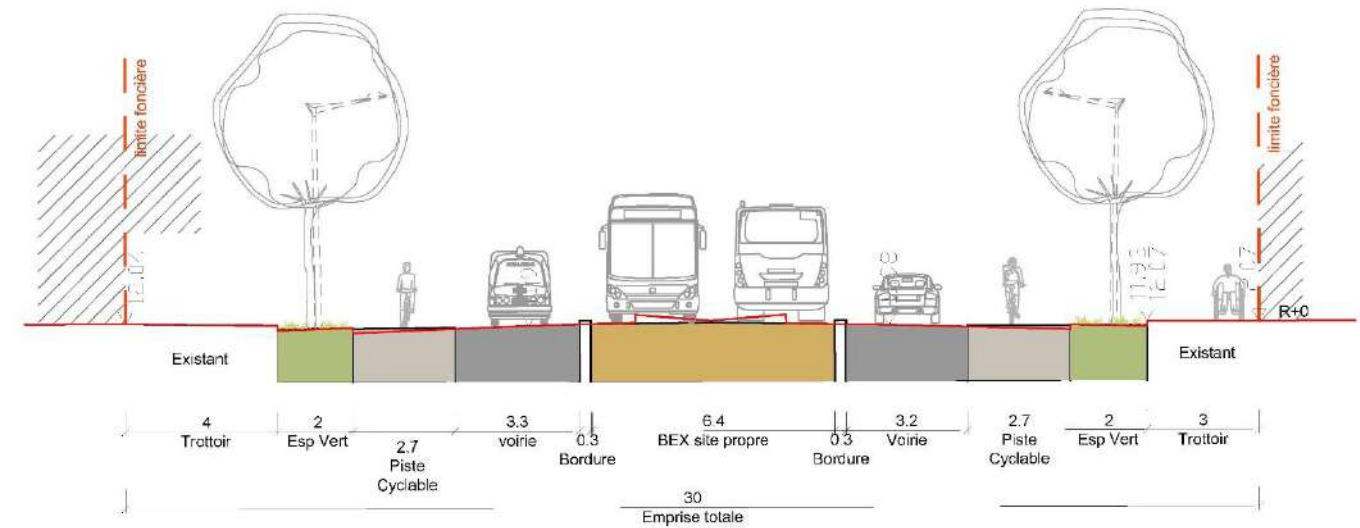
Coupe type sur le boulevard Pompidou en section courante
